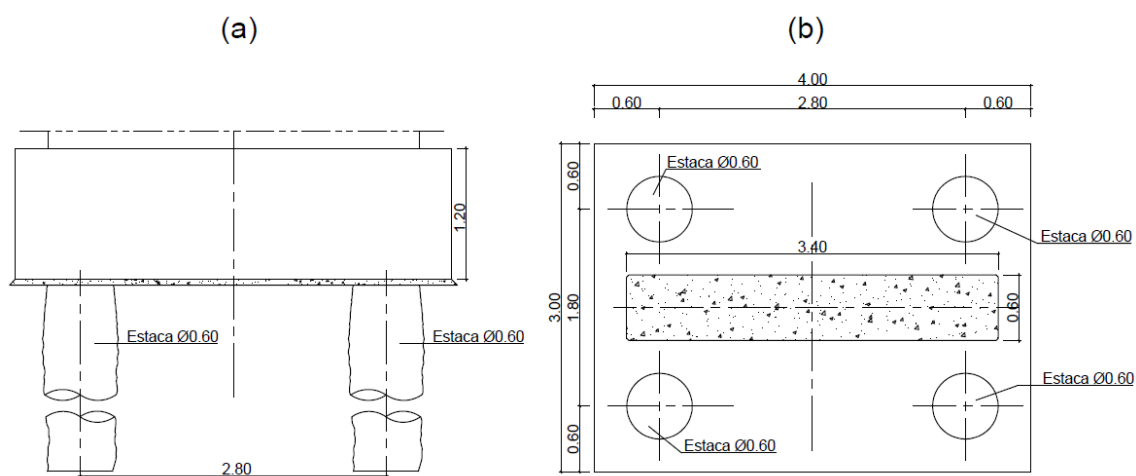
Fundação indirecta do pilar P2: (a) Alçado transversal; (b) Vista em planta [2]
